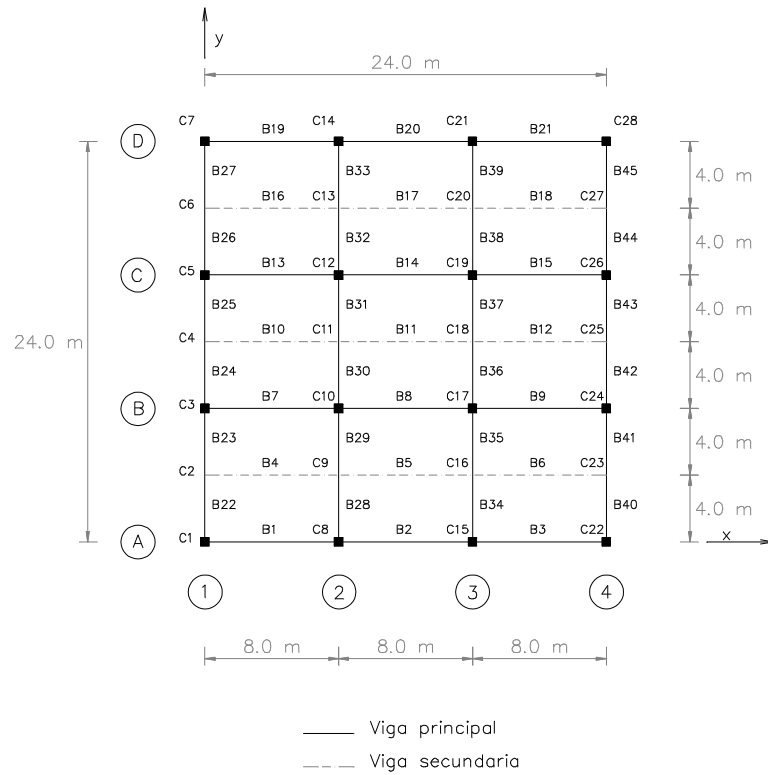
Planta tipo con ubicación de vigas e hileras de columnas del modelo matemático tridimensional, edificios de 7 y 17 niveles
